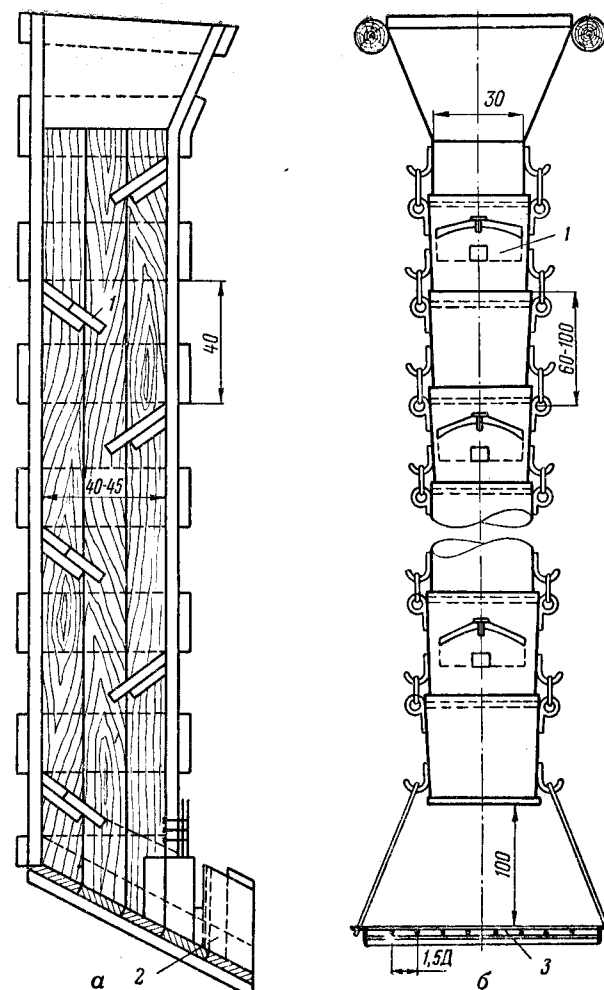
Хоботы для вертикального транспорта бетона самотеком:
